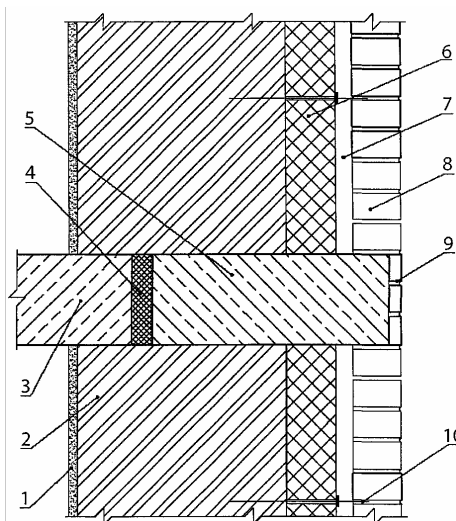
Розрахункова схема конструкції: 1 – внутрішня штукатурка; 2 – несуча стіна; 3 – плита перекриття; 4 – додатковий теплоізоляційний вкладиш; 5 – залізобетонний консольний пояс через 3 – 4 поверхи; 6 – шар теплової ізоляції; 7 – повітряний вентиляований прошарок; 8 – опоряджувальний шар із цегли або стінових дрібноштучних каменів із вентиляційними отворами у вертикальних швах; 9 – клінкерна фасадна цегла; 10 – металевий зв'язок із фіксатором теплоізоляційного шару
